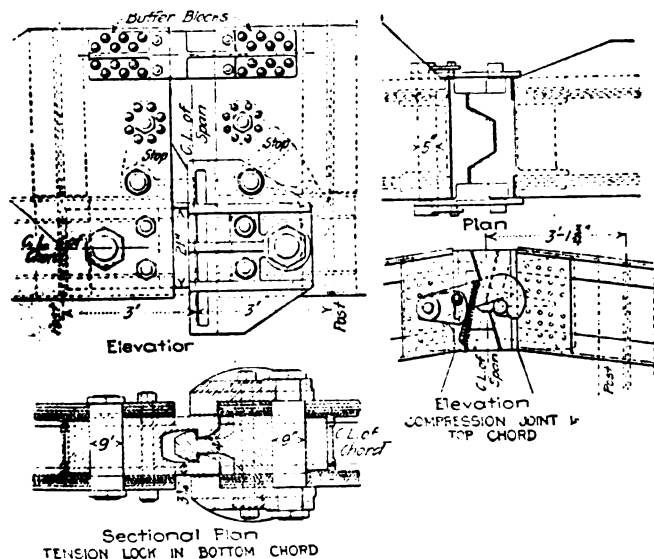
Dettaglio dei collegamenti delle volate del ponte levatoio.
